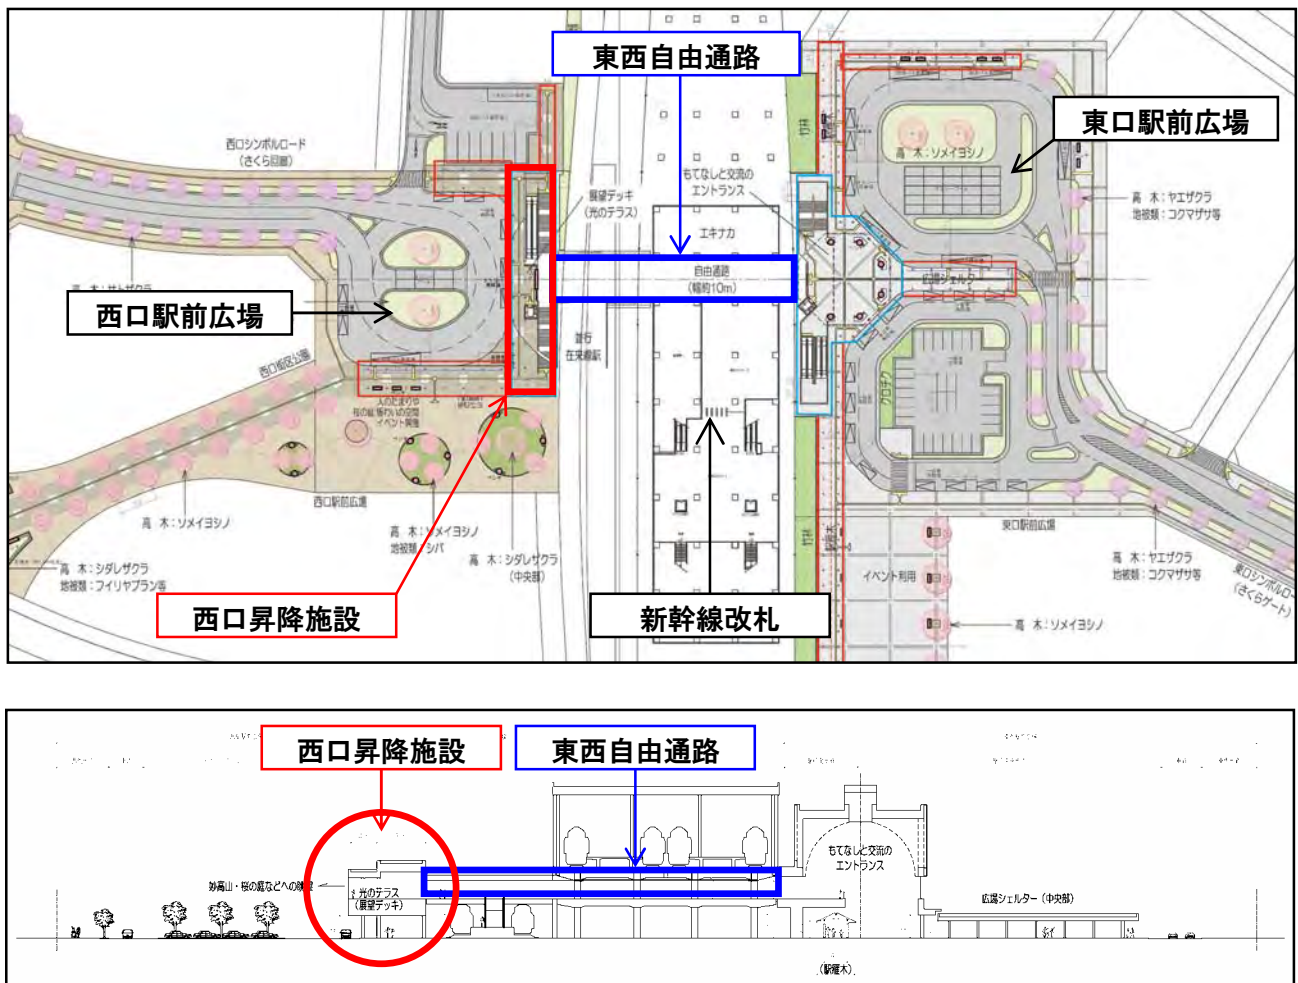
西口昇降施設の配置 (上：平面図、下：断面図)
